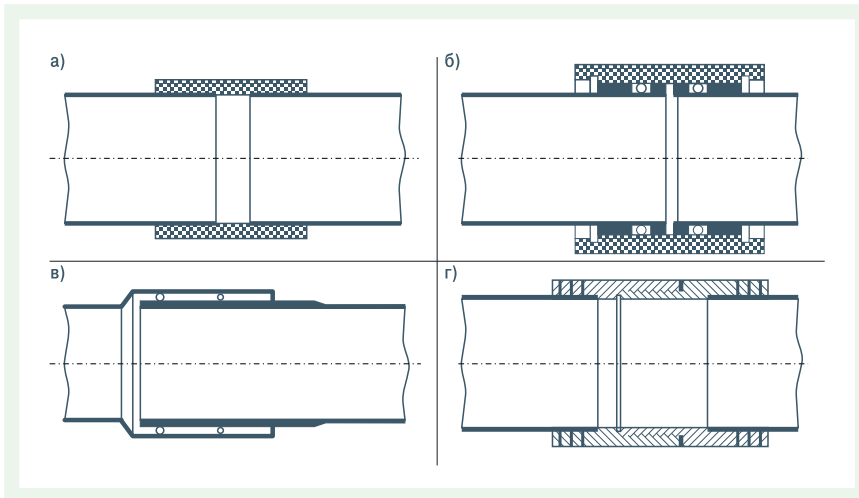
Соединения полимеркомпозитных труб из базальтопластика (выборка из ТУ 2296-001-71653326-04; а — клеевое; б, в — с резиновыми кольцами муфтовое и раструбное; г — резьбовое)
